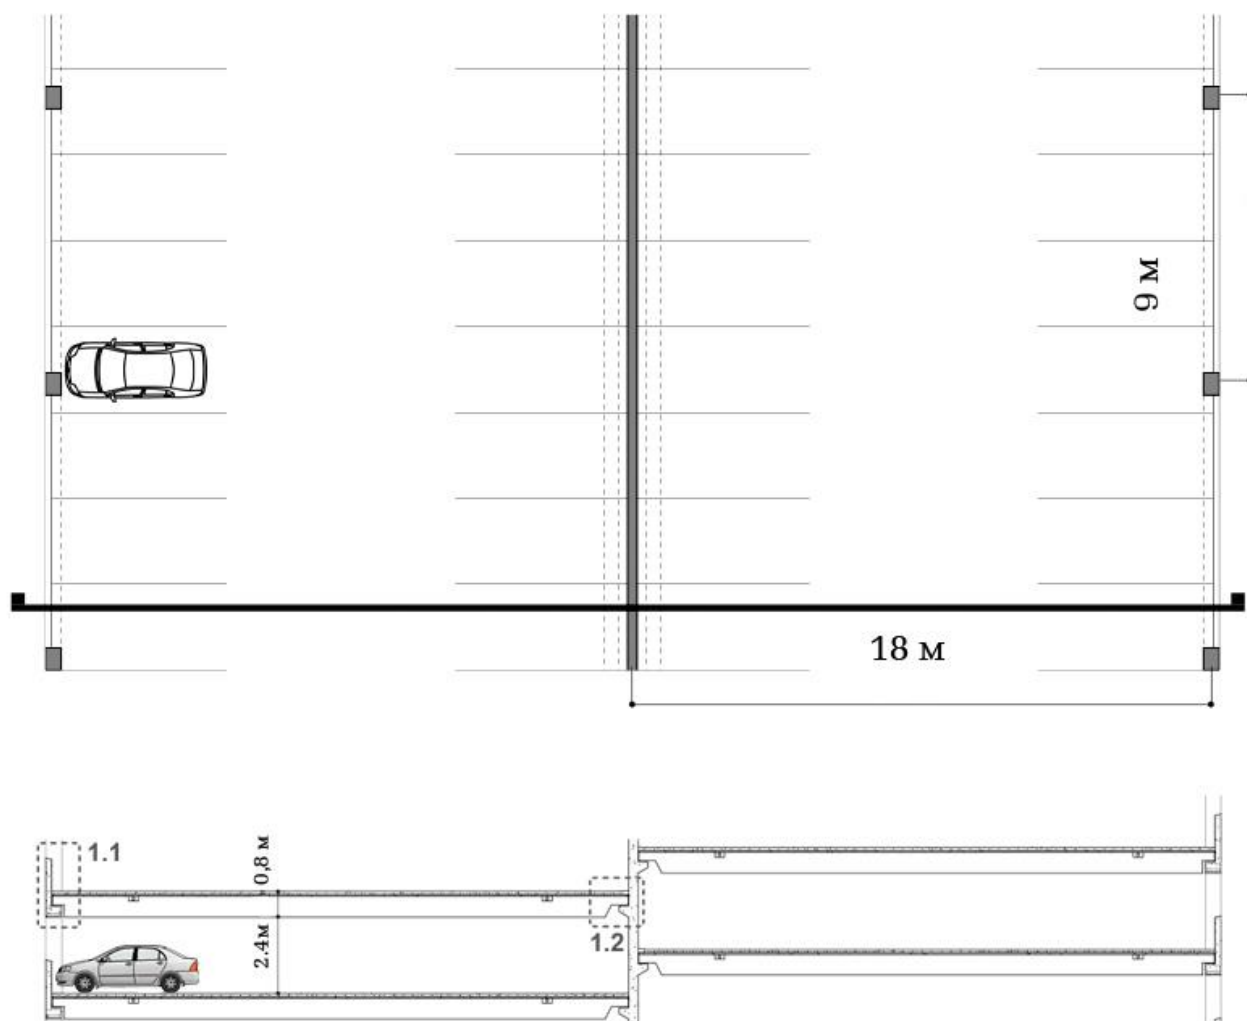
Схематичное изображение опирания ребристой плиты перекрытия на колонны.
